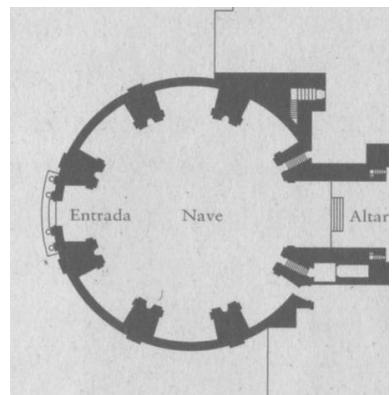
Planta da igreja do Convento da Serra do Pilar, V. N. Gaia (Planta)
